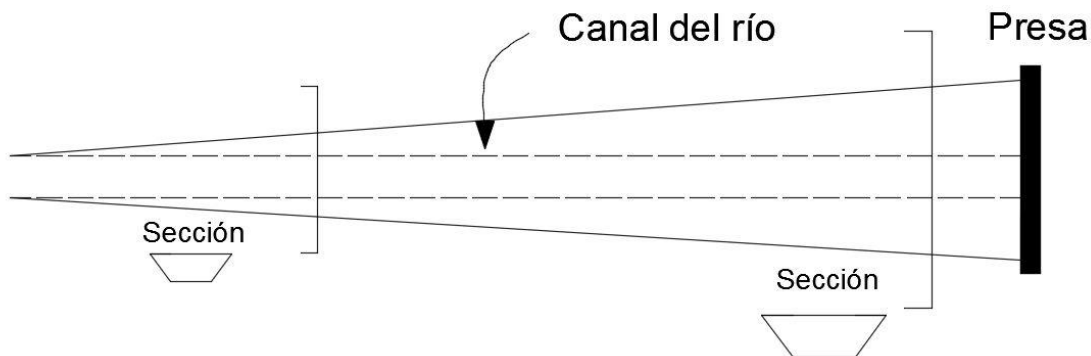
Vista en planta de la geometría simplificada de la presa (Atkinson 1996)
